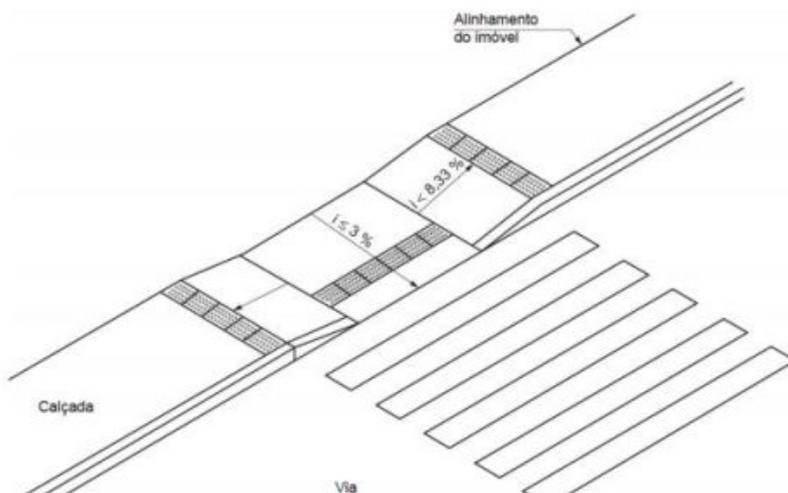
Rampas com sinalização de piso tátil, faixa sem elevação, calçada mais estreita.
